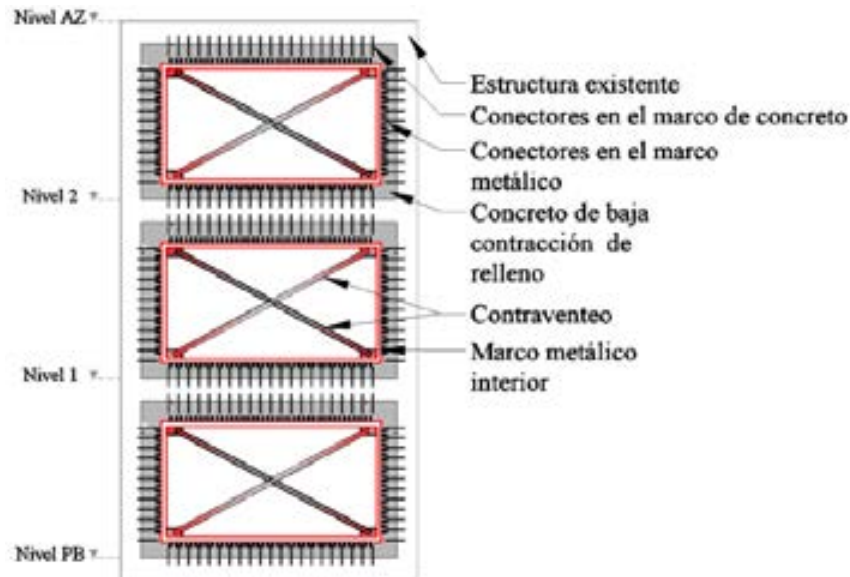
Vista frontal del marco de conexión con la estructura existente mediante concreto de baja contracción
